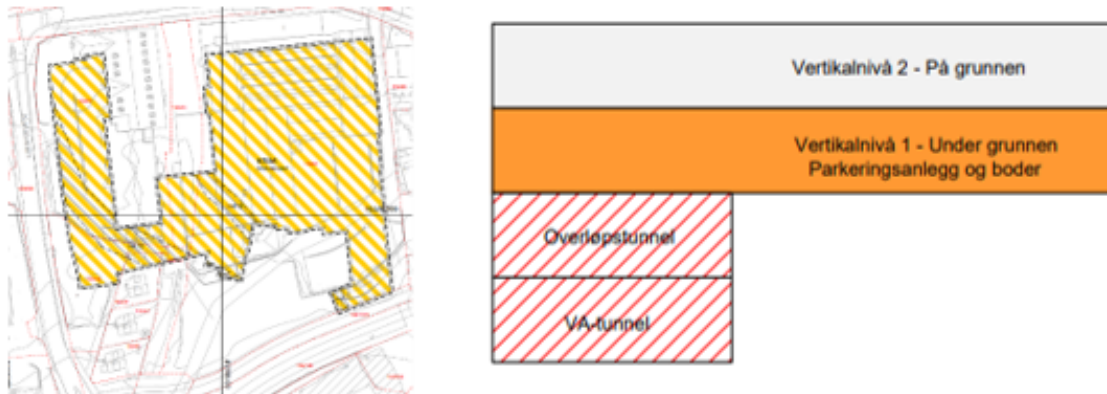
T.v.: Fellesparkering under bakken i plan. T.h.: Fremstilling av de ulike vertikalnivåene under/på grunnen.
